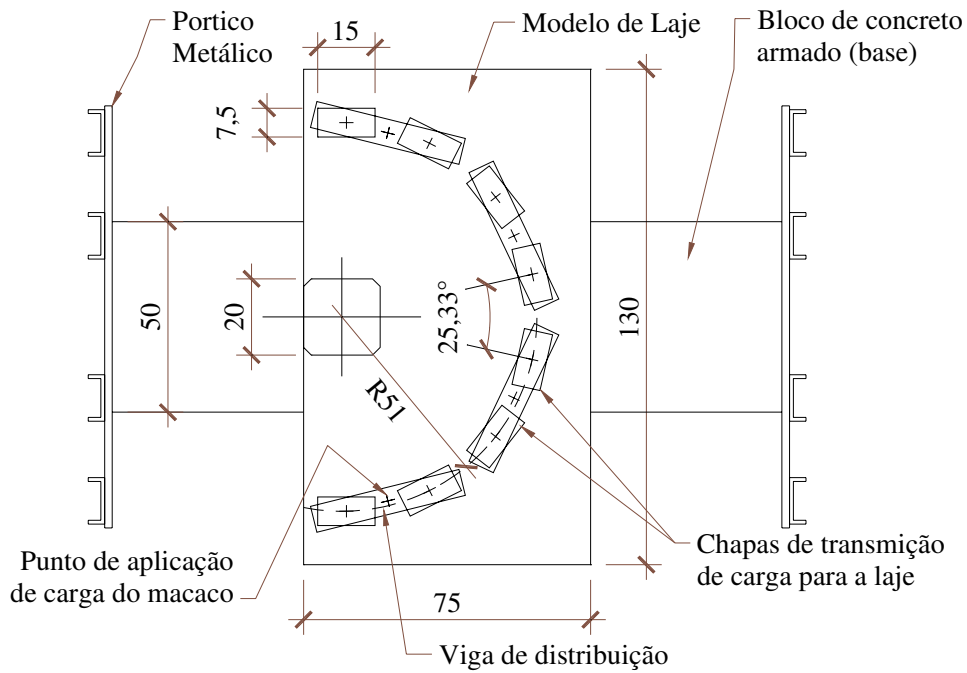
Planta do modelo de ensaio utilizado por TAKEYA / 1983
